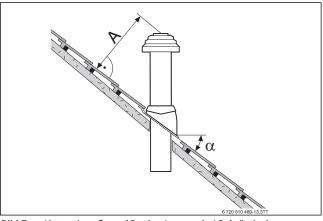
Abstandsmaße und Dachneigungen bei Schrägdach
